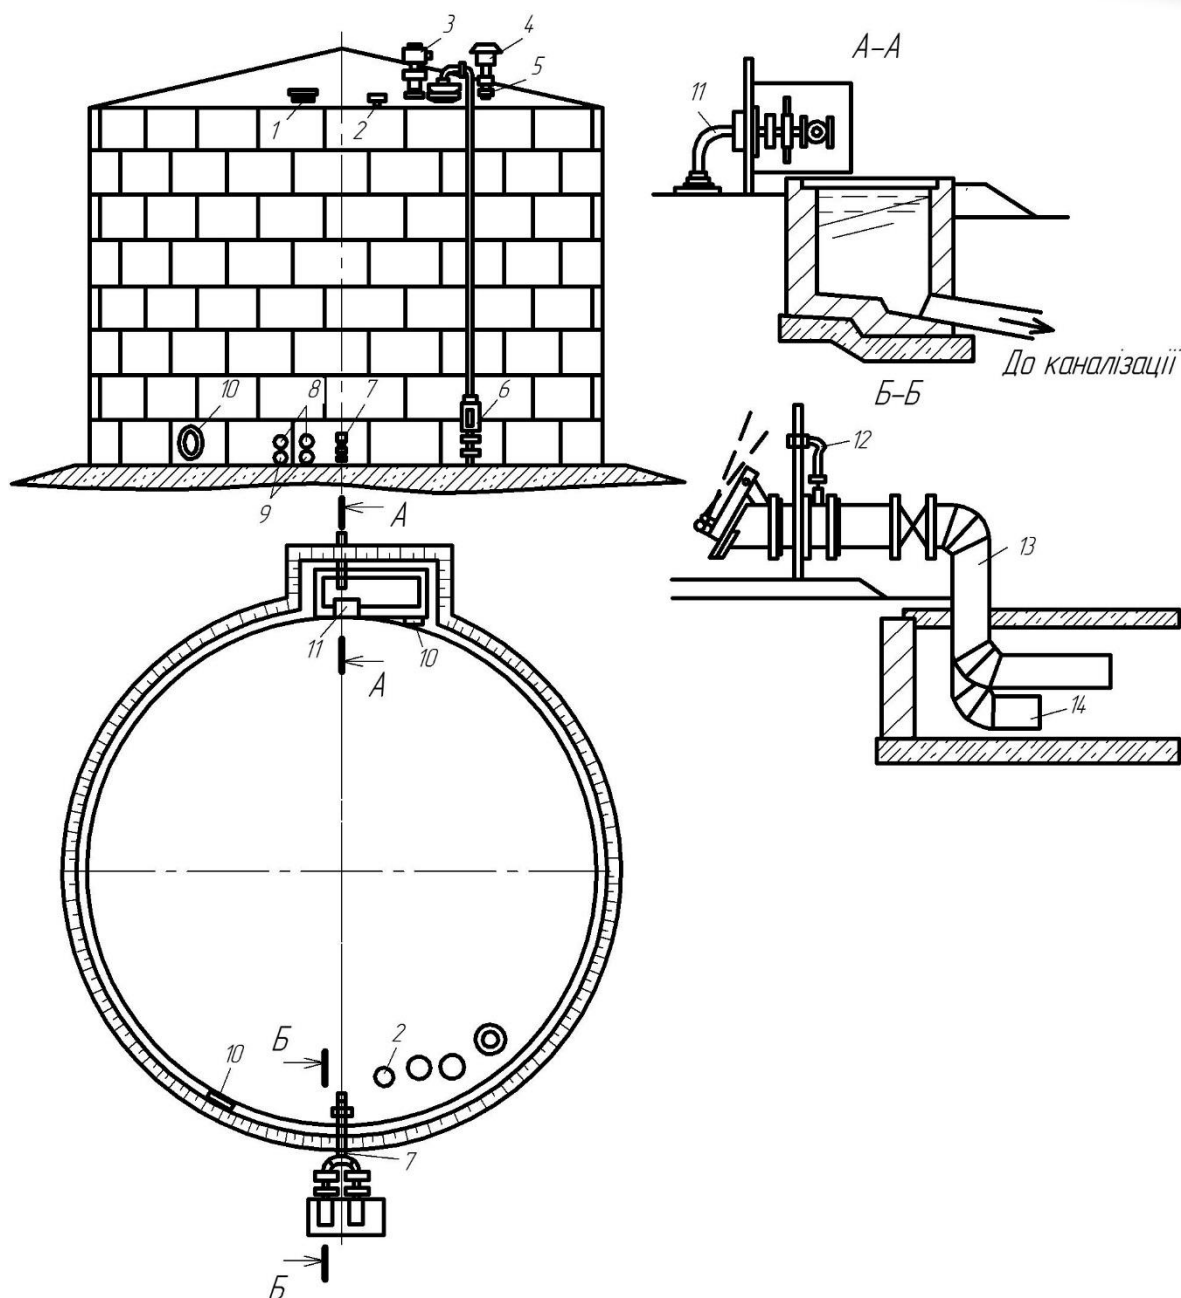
Металевий (зварний) наземний резервуар для зберігання дизельного палива:
